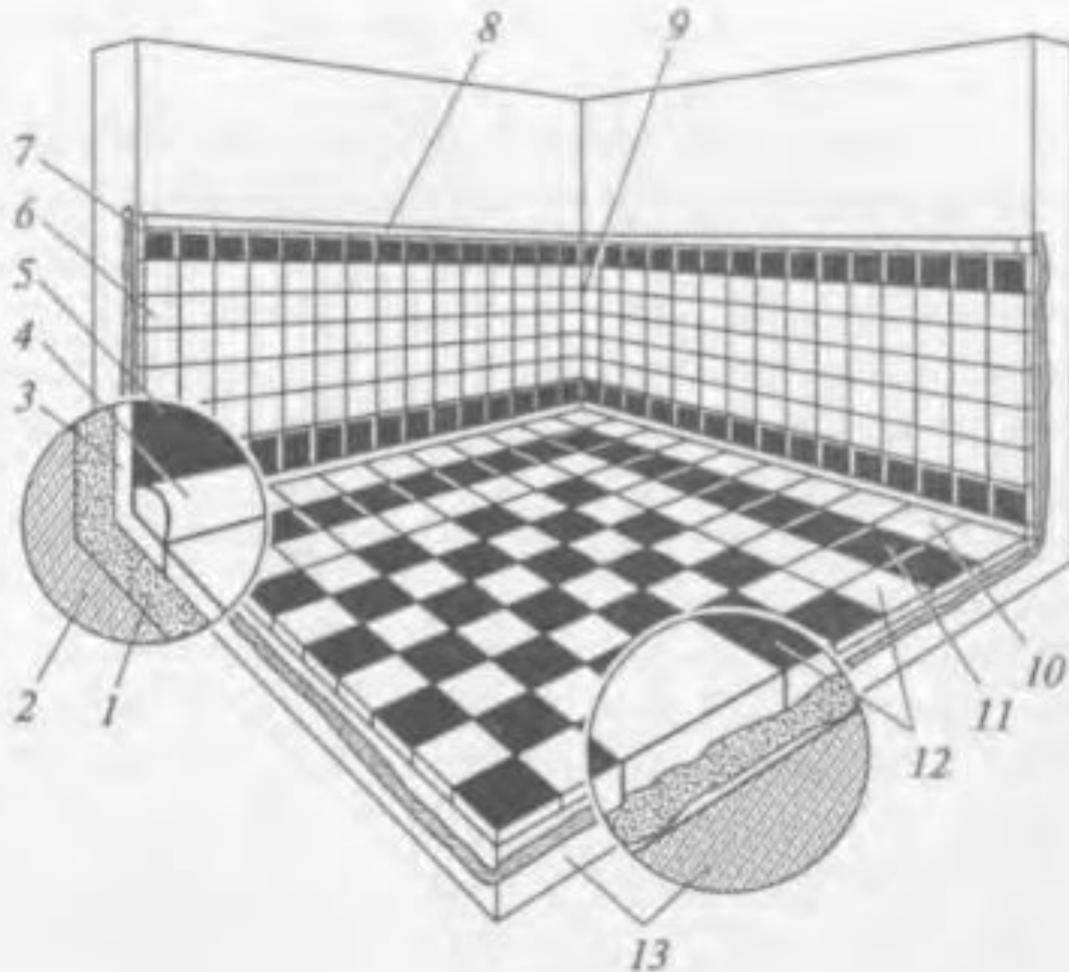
Конструкция облицовки стен и полов: 1— прослойка из раствора; 2— жесткое основание; 3— облицовочное покрытие; 4— плинтус; 5 —цоколь; 6— основное поле облицовки; 7, 11 —фризы; 8— карниз; 9 —внутренний угол; 10— заделка; 12— фон; 13— основание
